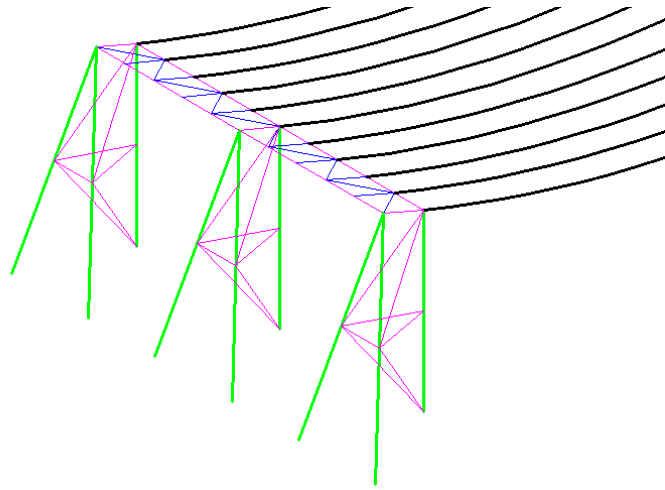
Estructura de cubierta (cables, viga inclinada y apoyos)
